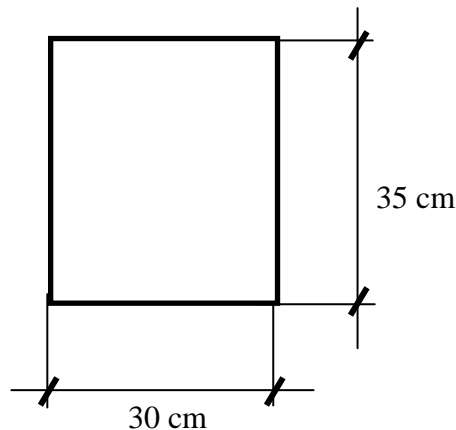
Dimensions de la section transversale des poutres secondaires
